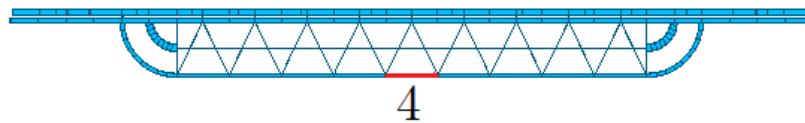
Étude poussée d'une panne métallique, vue en plan.
